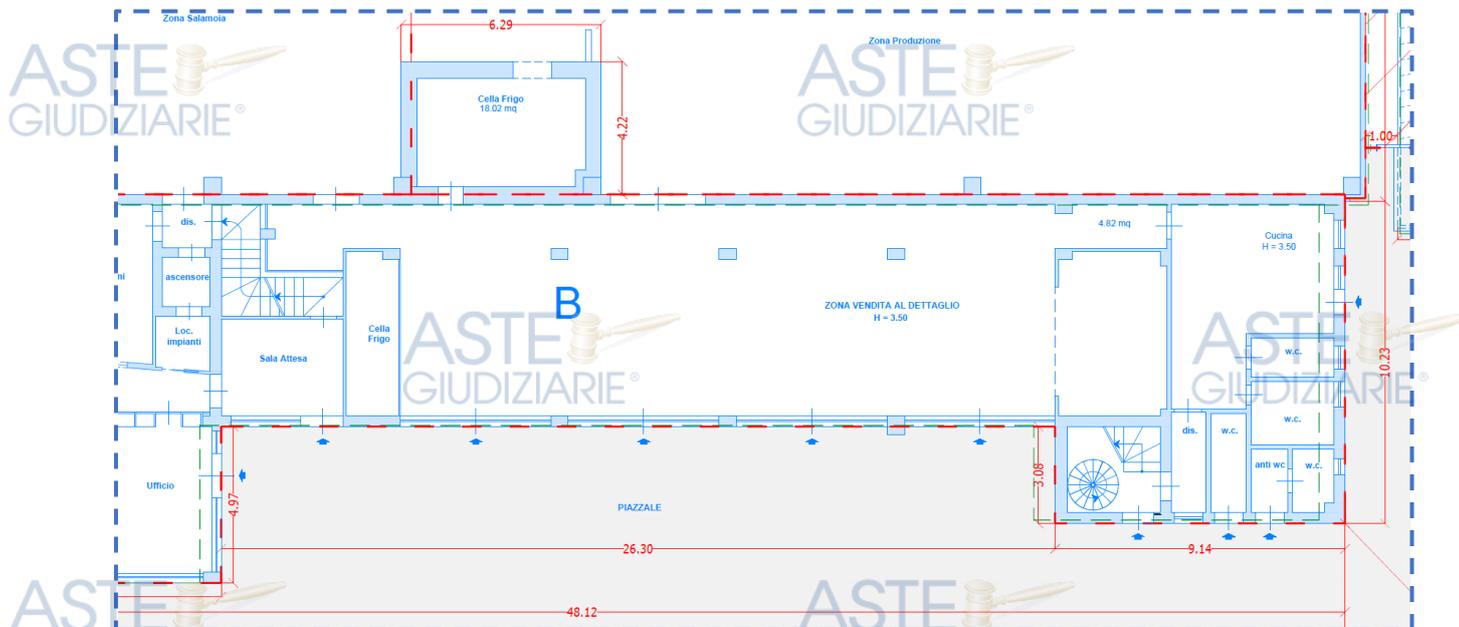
stralcio Tavola 1C.1 – sovrapposizione planimetria di rilievo con sagoma consistenza titolo edilizio
